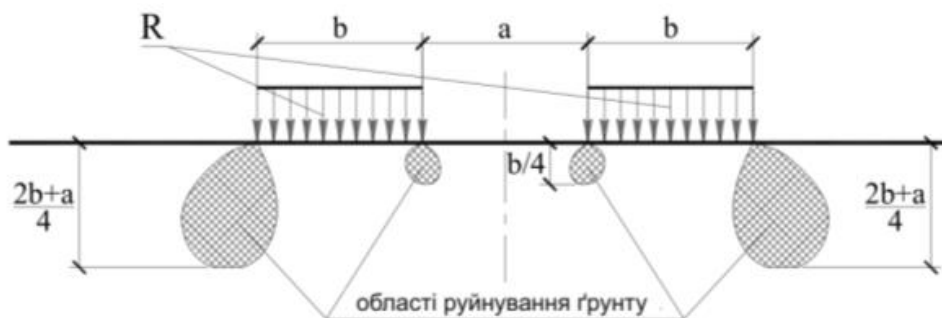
Області руйнування в основі двох стрічкових фундаментів, що відповідають розрахунковому опору ґрунту
